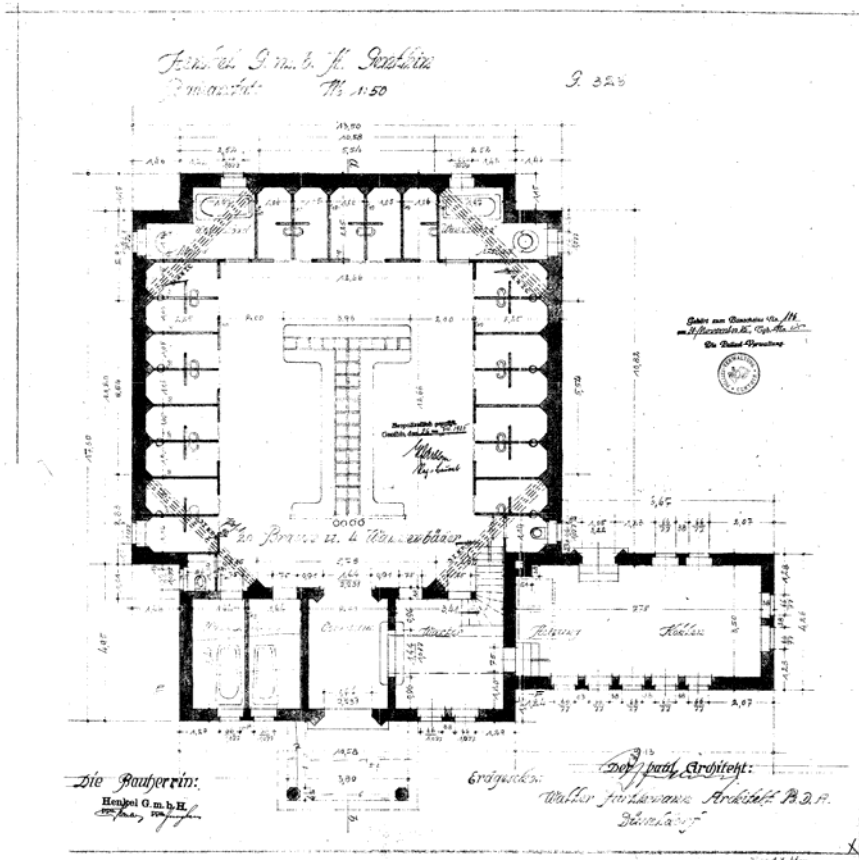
Badehaus, Grundrisszeichnung von 1925 – Architekt: Walter Furthmann
